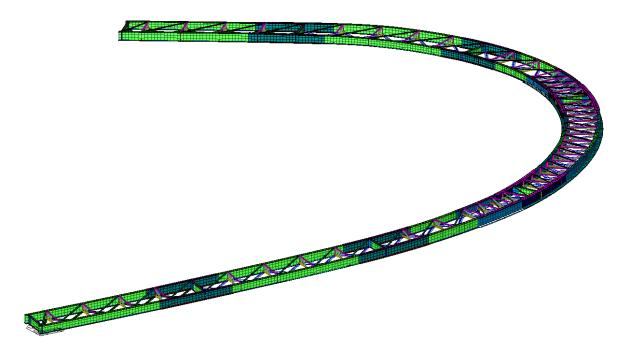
Sovrappasso di uscita - vista 3D della carpenteria metallica
